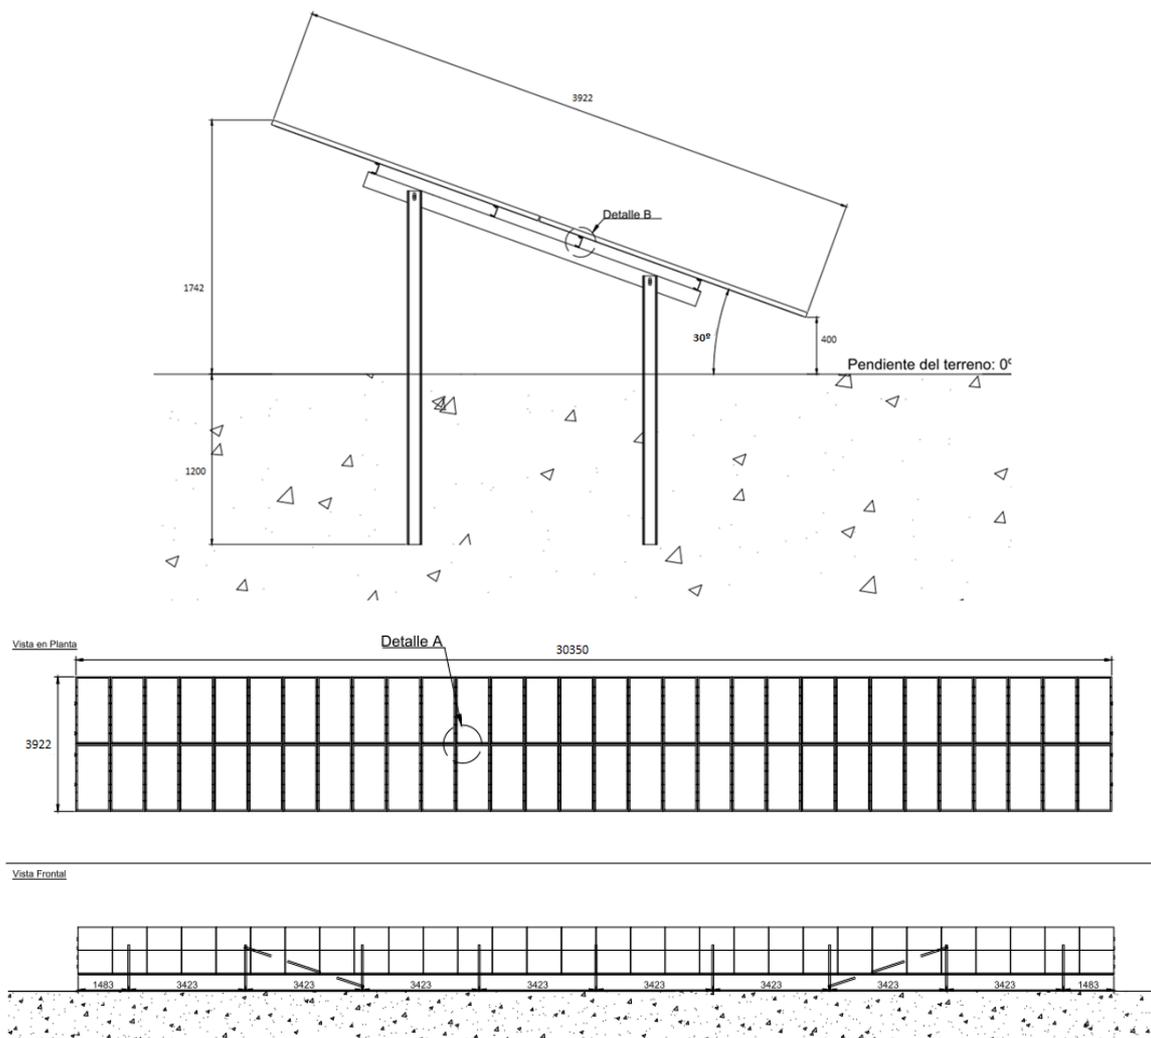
a. Vista de perfil, planta y frontal de la estructura de soporte 2Vx30. Fuente: Proyecto de Ejecución.
